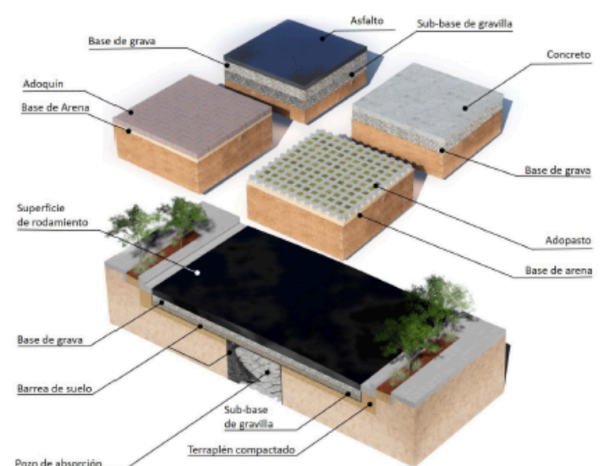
Ejemplos de pavimentos permeables (IMPLAN, 2019).
